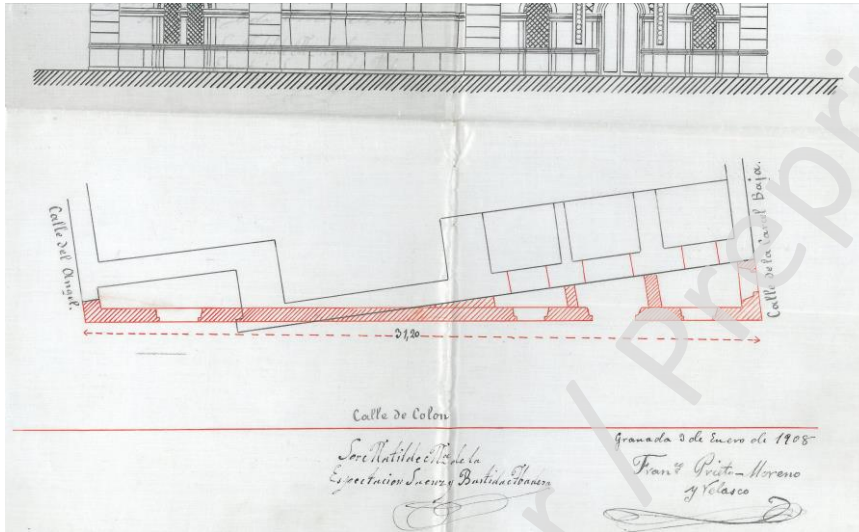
Plano del alzado y planta de la nueva fachada del convento. Año 1908
